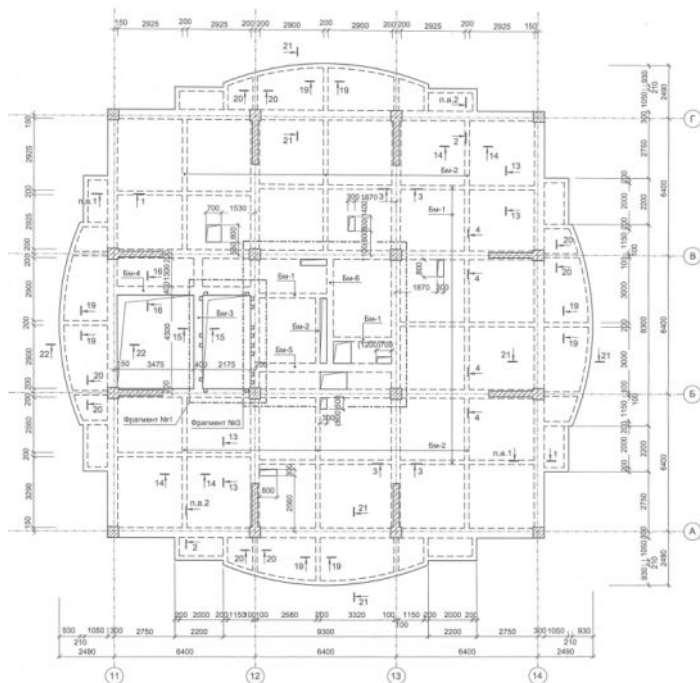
Общий вид и конструктивная схема в плане 12-этажного здания
